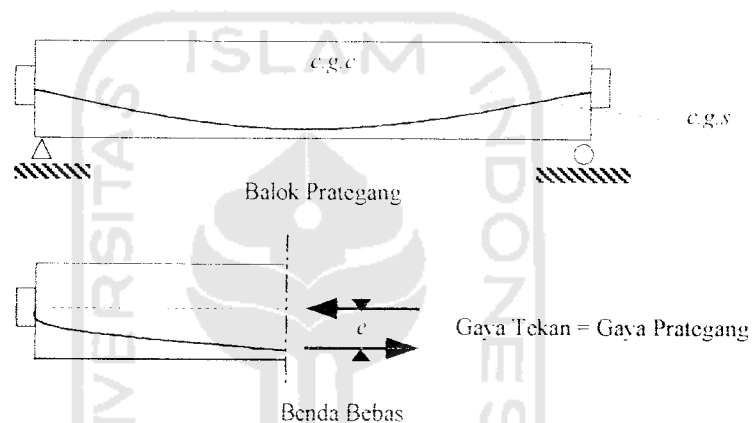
Distribusi tegangan sepanjang penampang beton prategang eksentris
